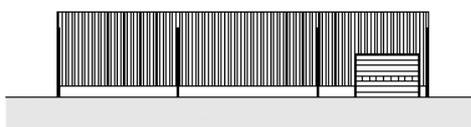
Prospetto Sud-Ovest - Schema
